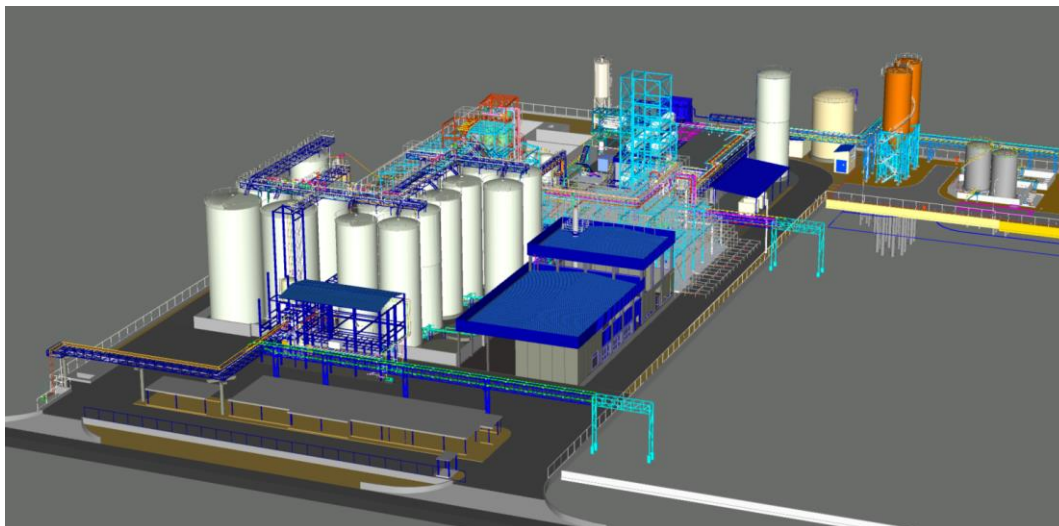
Visualización 2 en 3D de la planta [Fuente: Planta]
